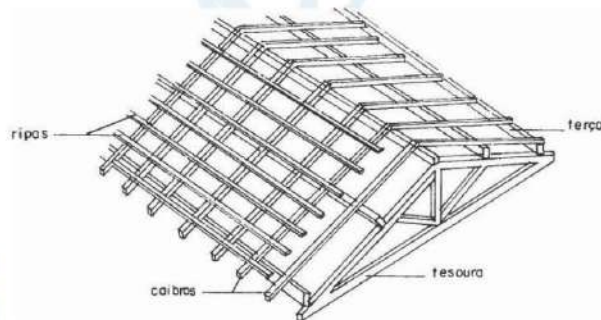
Ilustração de nomenclatura de elementos de estrutura de madeira do telhado.
